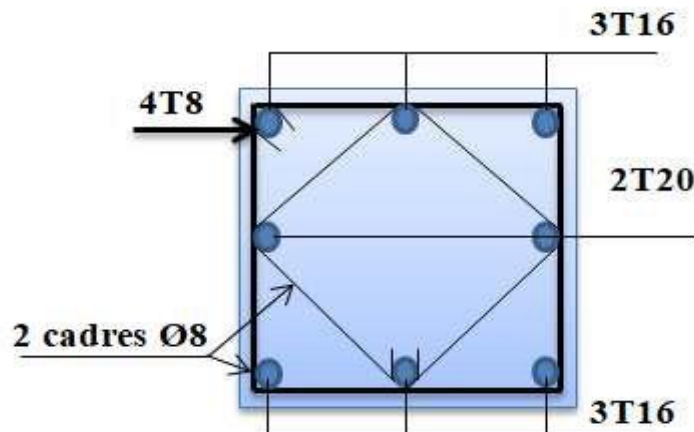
Schéma de ferrailage des poteaux (30x40).
